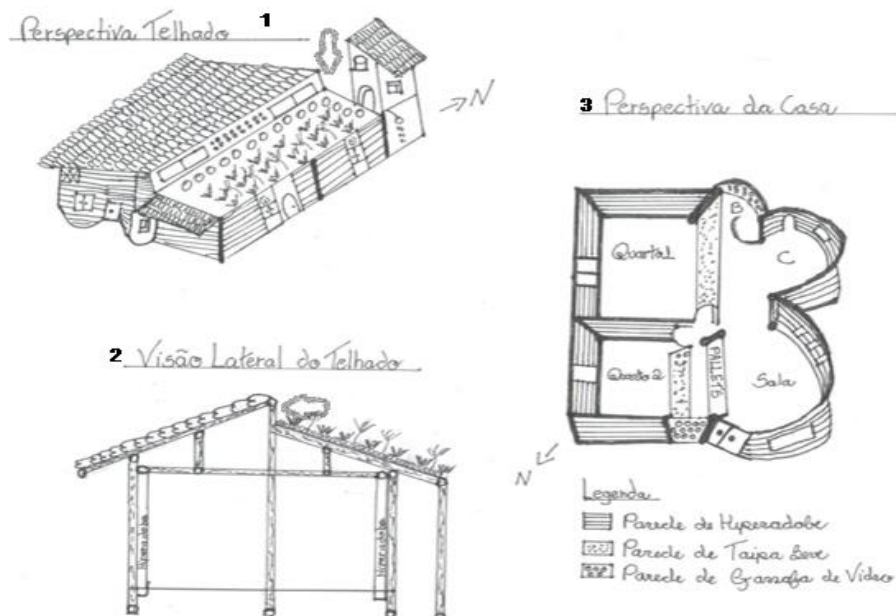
1) Perspectiva Telhado lateral sudeste; 2) Visão lateral do telhado corte central 3) Perspectiva da Casa e Técnicas Utilizadas para construção. Ilustração Renata Oliveira
